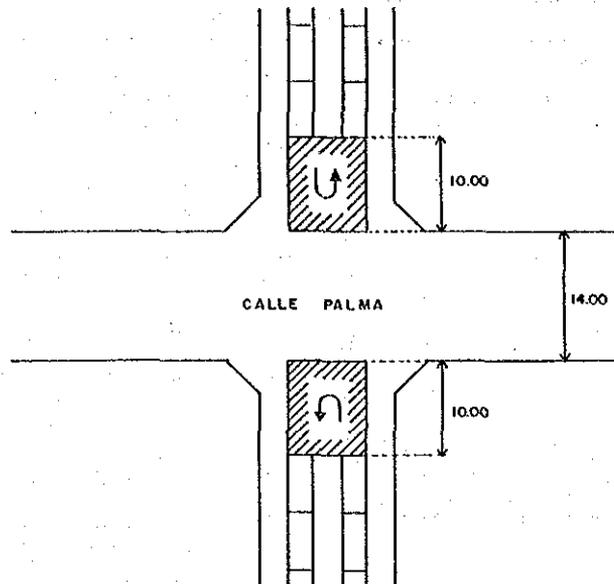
AREA DE MANIOBRA DE LAS CALLES TRANSVERSALES A LA CALLE PALMA
